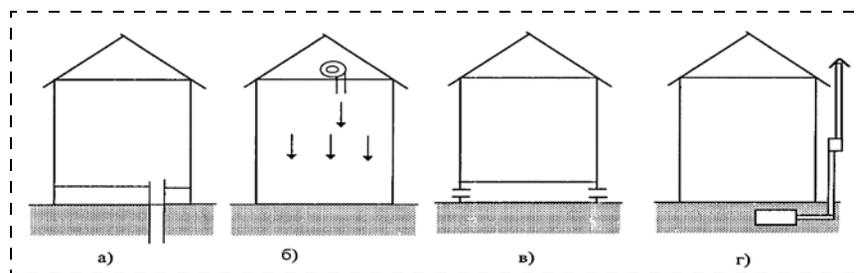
Схемы по снижению содержания радона в воздухе жилых помещений: а — герметизация подпольных перекрытий (изоляция); б — создание повышенного давления внутри помещения; в — подпольная вентиляция; г — уменьшение подпольного давления
